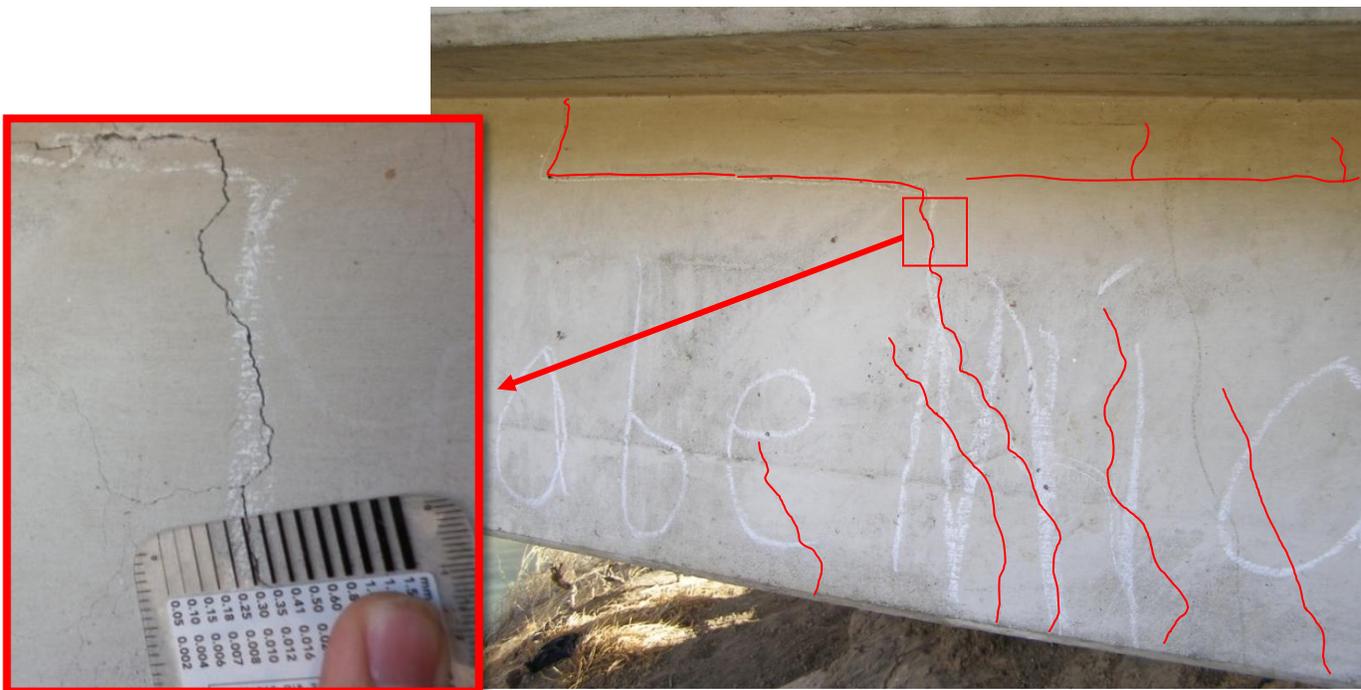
Detalle de eflorescencia en grietas transversales (tramo 2).
